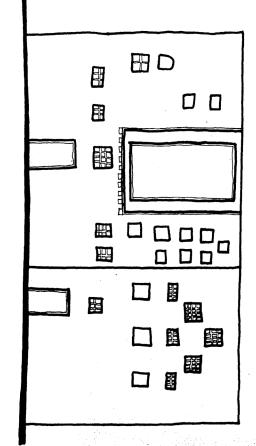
منزل القاضى عمر الدور الثاني - مسقط أفقى
